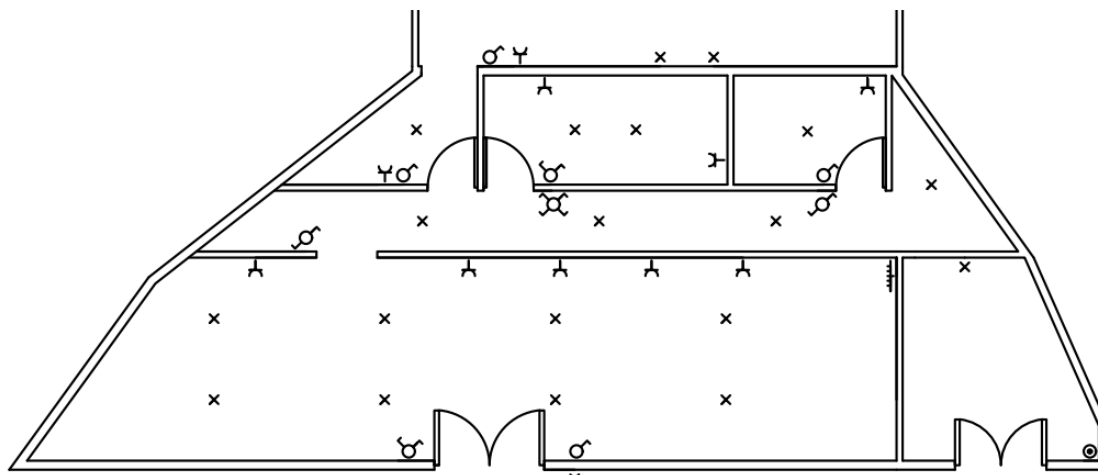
Esquema de la distribución de la instalación eléctrica en la planta baja.
